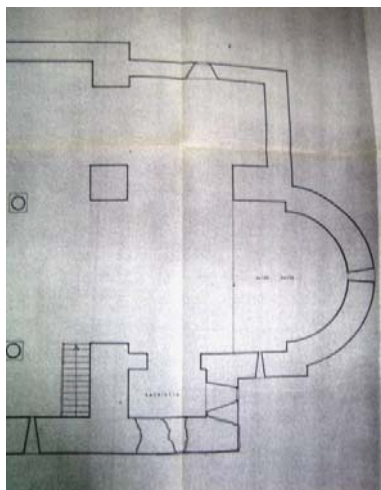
Detalle de la sacristía. Se marcan las grietas de la fábrica. AGA, IDD (3)115 caja 26/0645.
